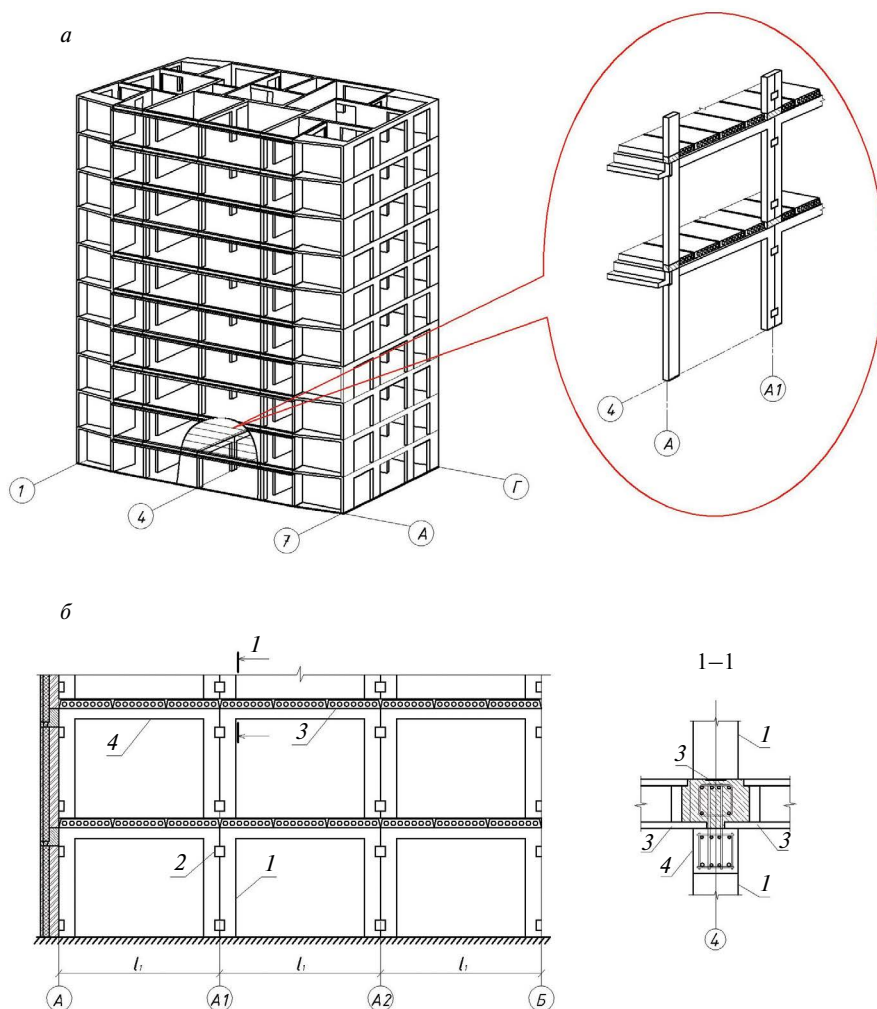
Здание из железобетонных индустриальных панельно-рамных элементов: а – конструктивная схема; б – фрагмент каркаса здания в зоне возможного разрушения от потери устойчивости колонны; 1 – стойка; 2 – закладная деталь; 3 – сборная плита перекрытия; 4 – сборно-монолитный ригель; 5 – центрирующий элемент стойки
